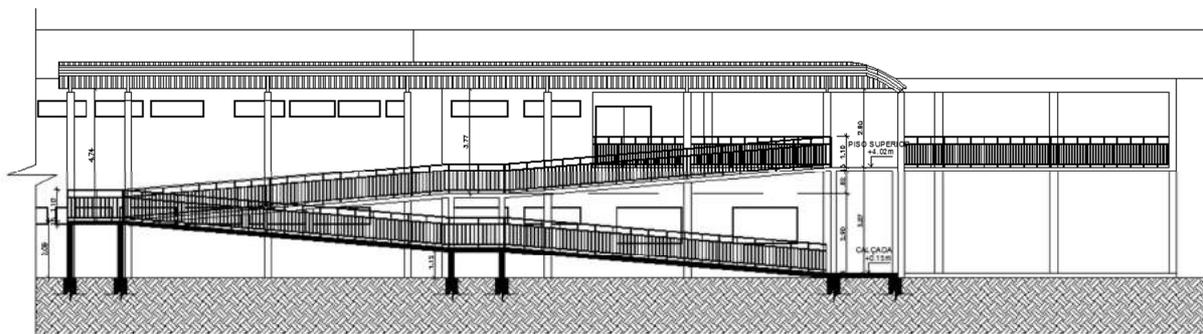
PAVIMENTO SUPERIOR - BLOCO ADMINISTRATIVO – CAMPUS PLANALTINA
